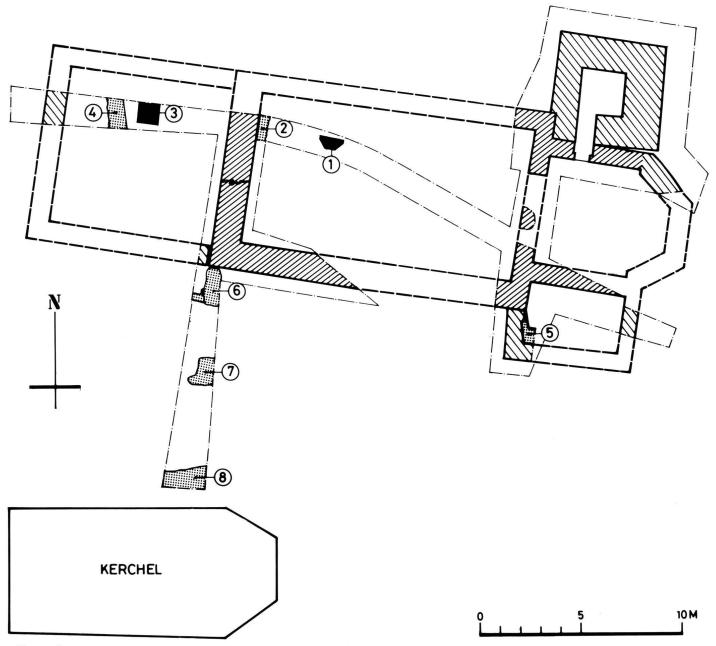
Rekonstruierter Grundriss der Alten Pfarrkirche von Muotathal. Massstab 1:200.
